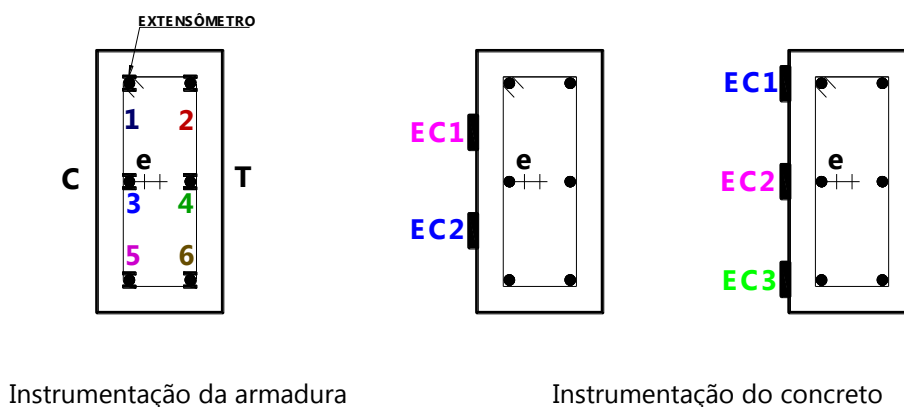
Posicionamento dos extensômetros na armadura e no concreto
